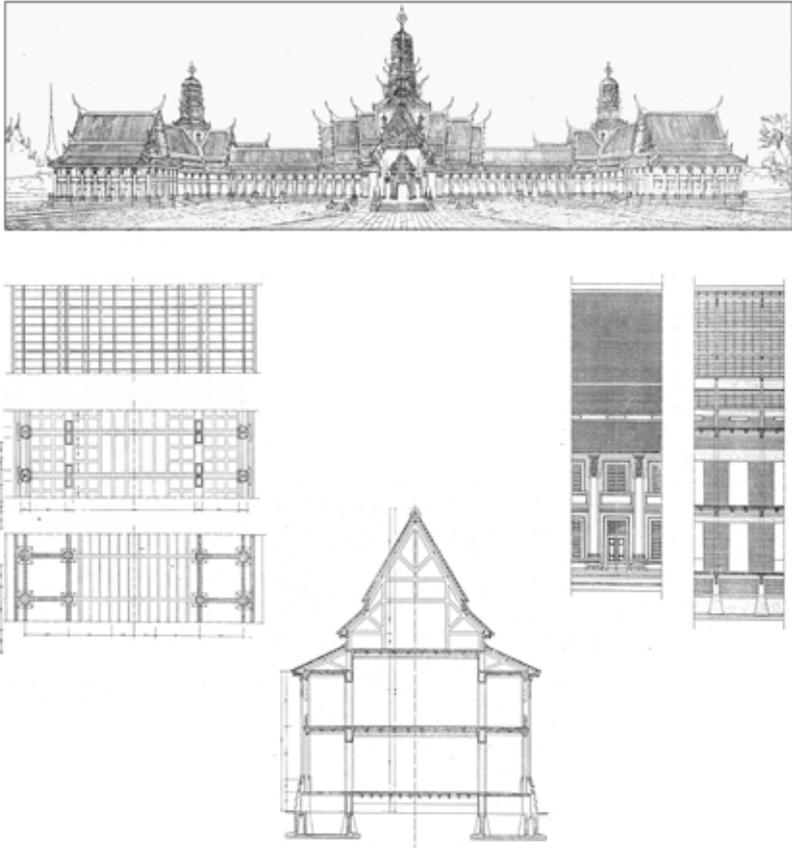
Mario Ceradini, progetto per la sede dell'Università di Bangkok: veduta prospettica, dettagli strutturali e decorativi, sezione longitudinale.
